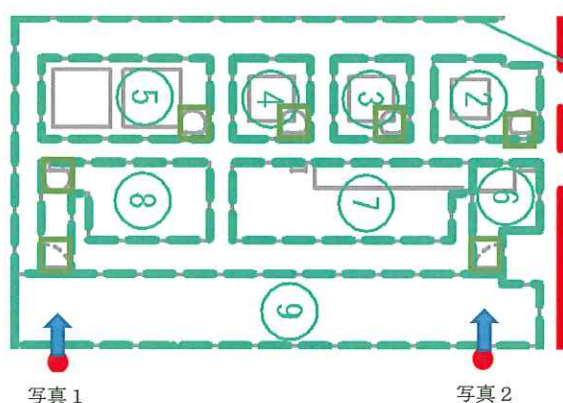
[ ] ②③④⑤⑥⑦⑧の平面図
